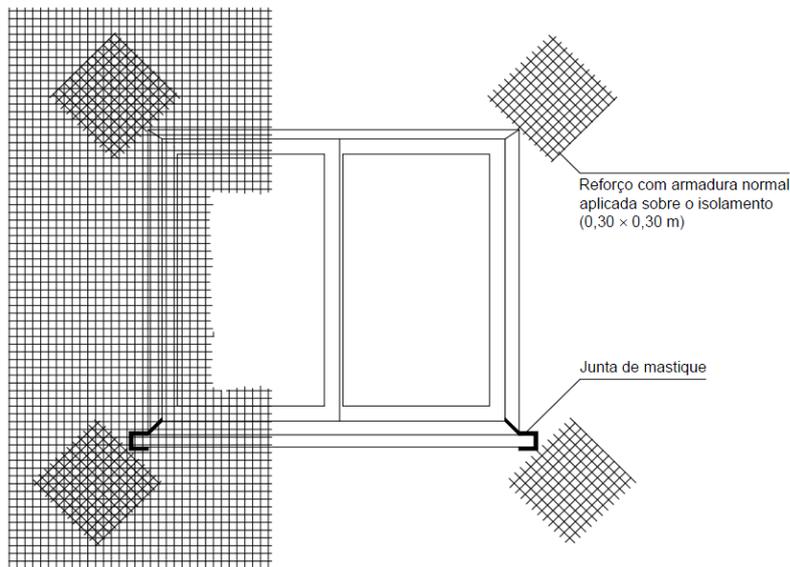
Reforço da armadura no contorno dos vãos da fachada [4]
